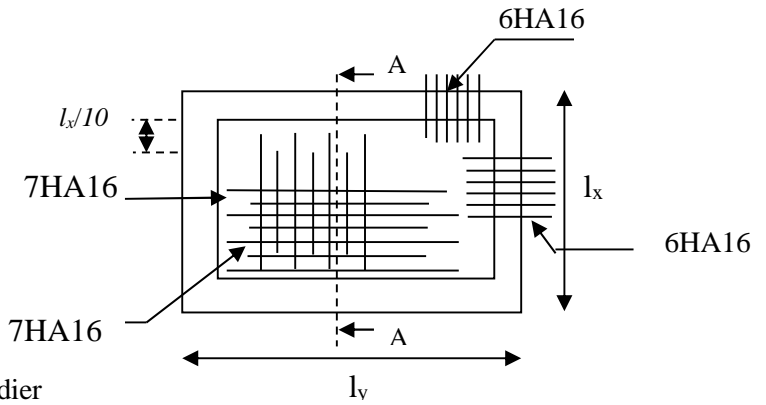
Schéma de ferrailage de la dalle de radier
